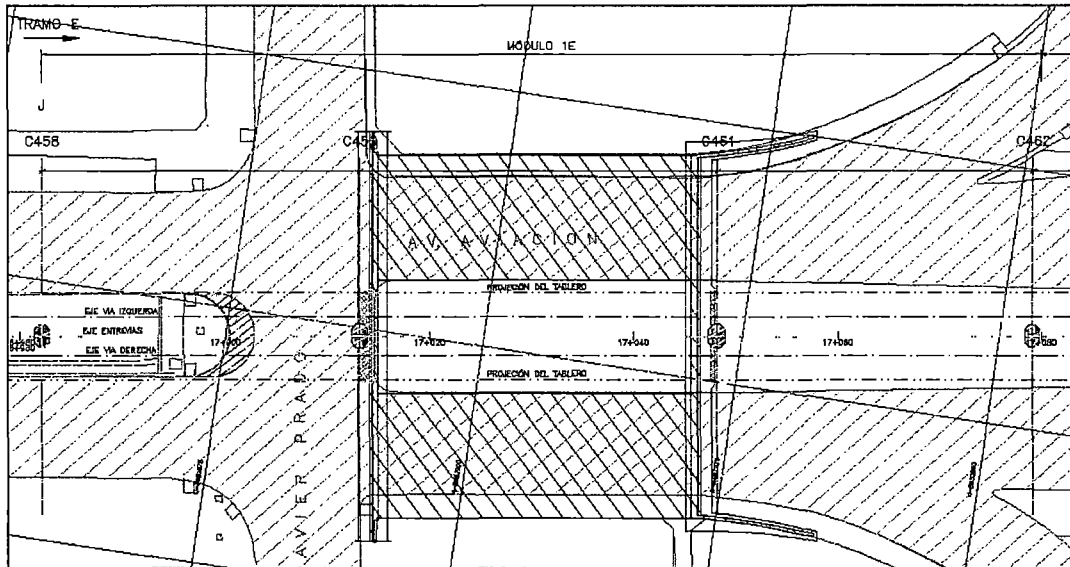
Vista Planta de Viaducto elevado cruce Javier Prado
